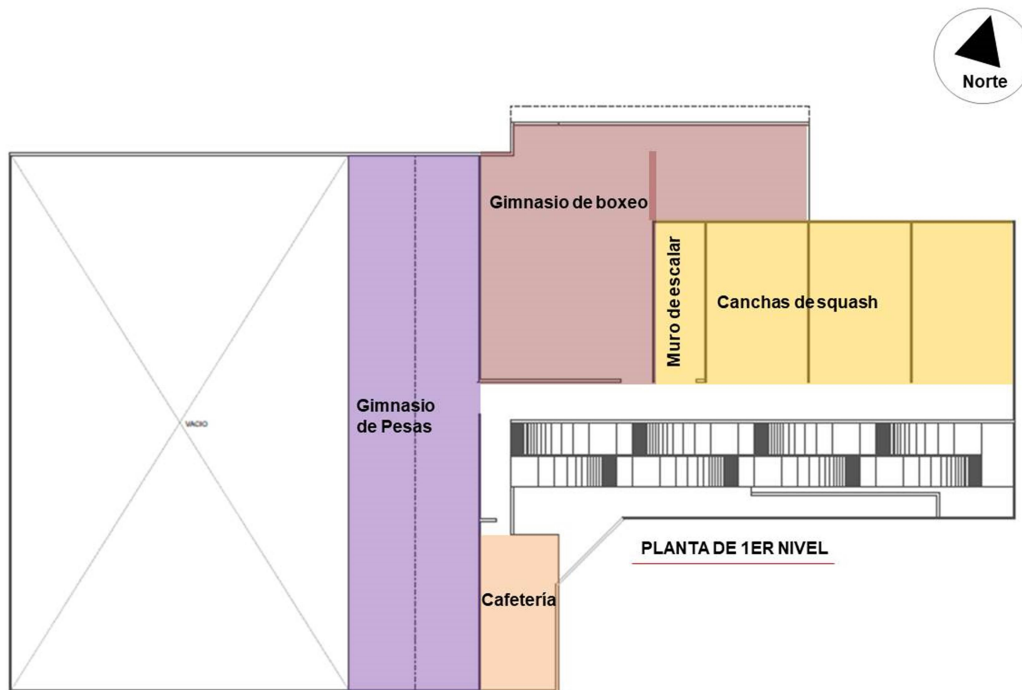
Zonificación planta nivel 1. Imagen 91: Zonificación planta nivel 2.
